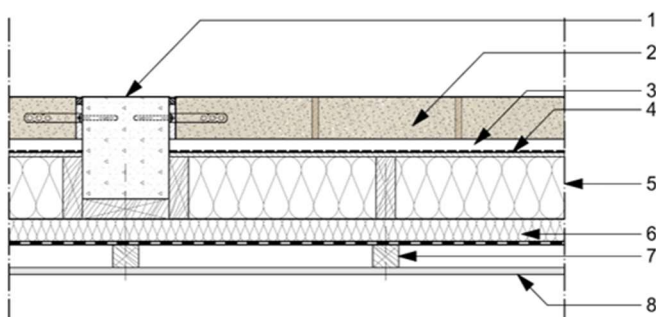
Cas B - Exemple avec ossature béton et Façade Ossature Bois
